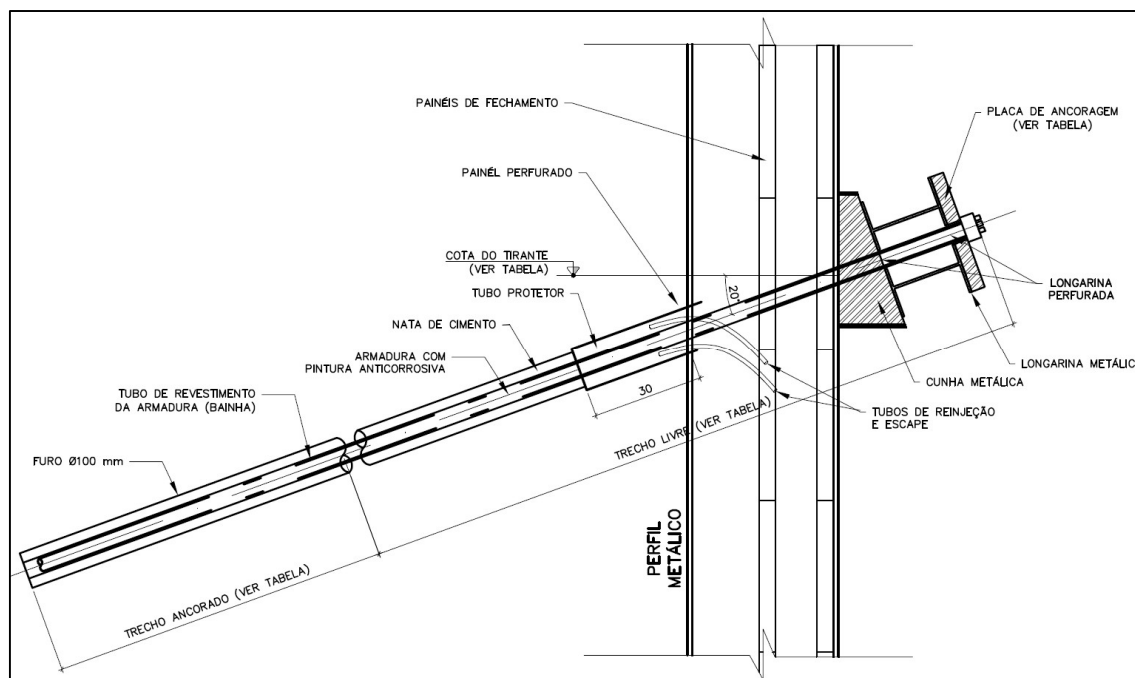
Detalhe do tirante e viga longitudinal metálica.
